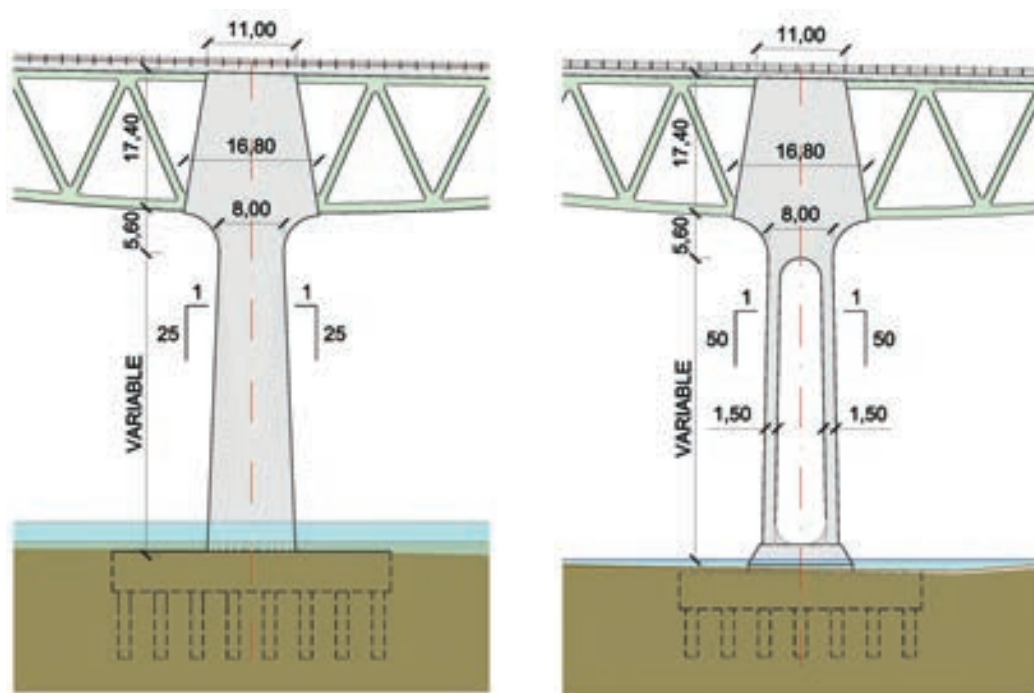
y 28b. Vista de las pilas centrales (P-6 y P-7) y laterales (P-5 y P-8)
